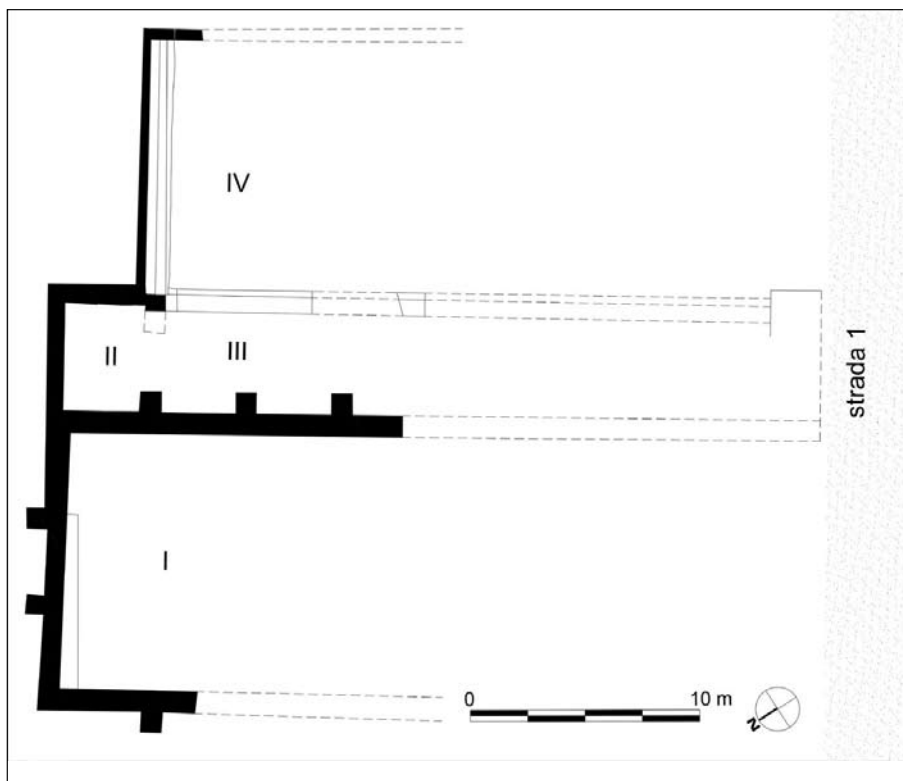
Planimetria dell'edificio con pilastri all'interno dell'area pubblica occidentale (da RINALDI c.s.).
